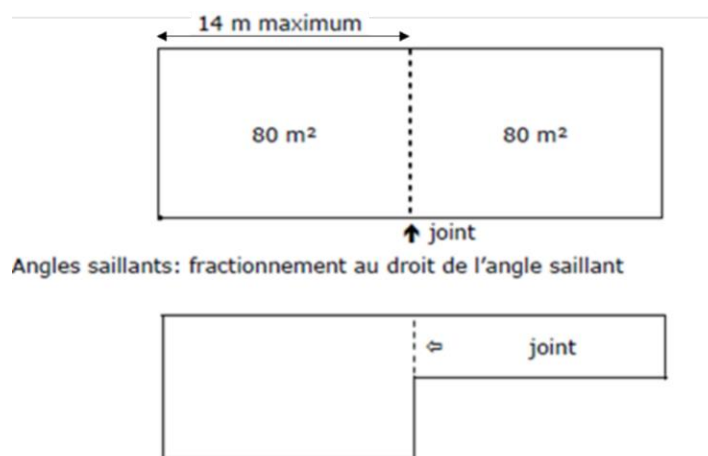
Fractionnement de la chape KALKISS SP EVOLUTION (hors planchers chauffants et/ou rafraîchissants)
